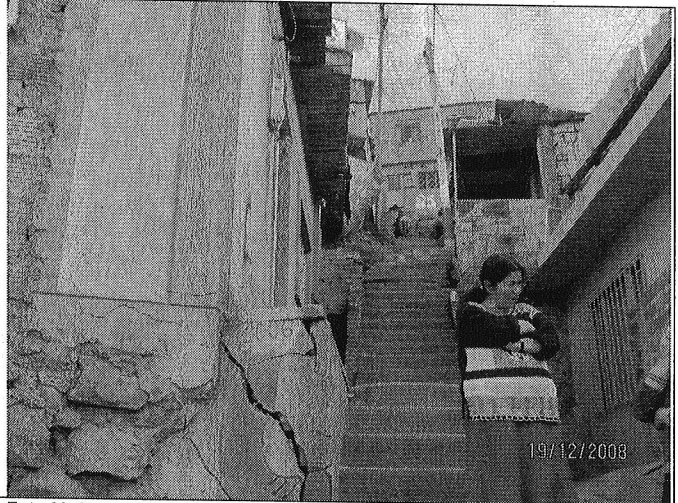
Desprendimiento de la estructura del andén localizado frente al lote 13 de la manzana 5 (De acuerdo a la Figura 1).
